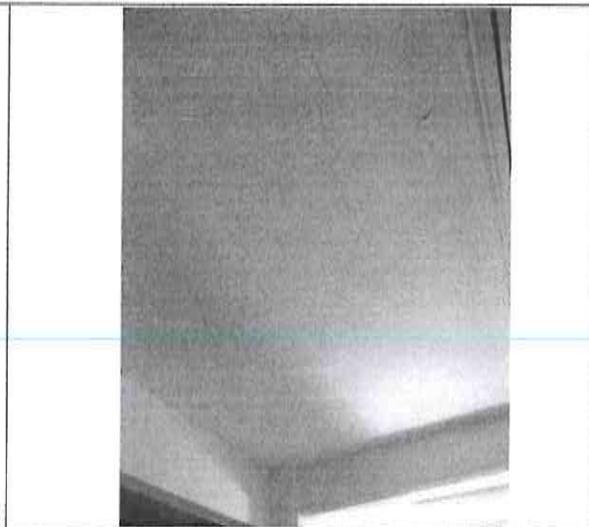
Exterior de losa que presenta fisuras en lecho bajo.
